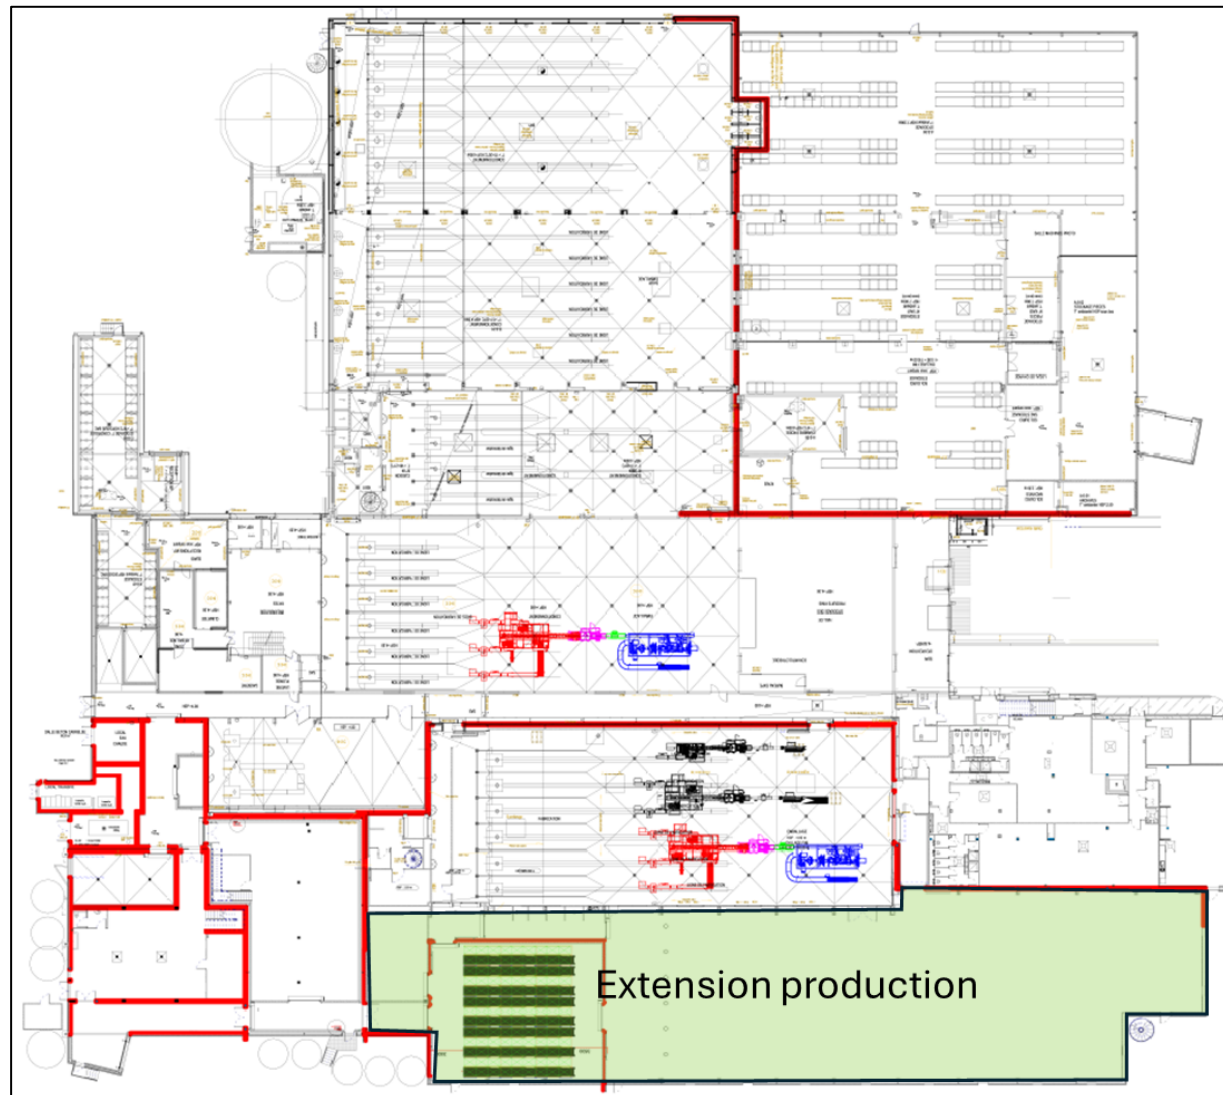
Plan des murs coupe-feu de l'installation (source : AREA)
